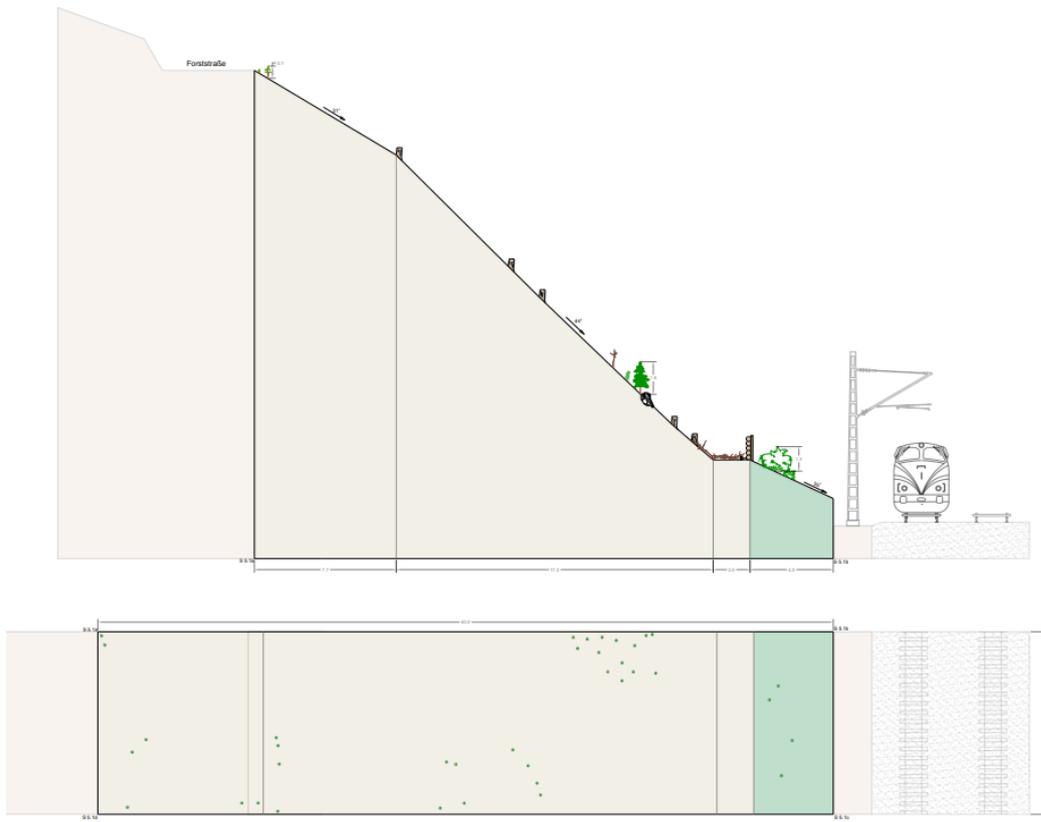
Fläche 5.1 – Querschnitt und Grundriss.
